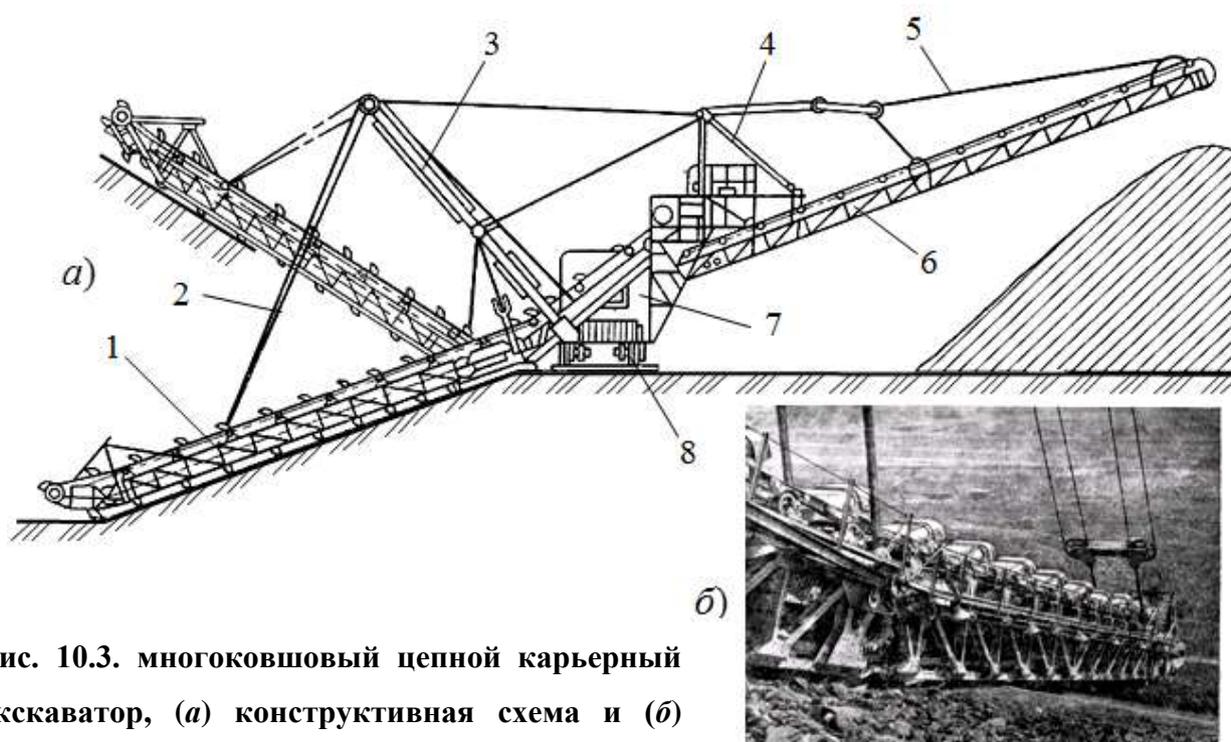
многоковшовый цепной карьерный экскаватор, (а) конструктивная схема и (б) фоторисунок.
